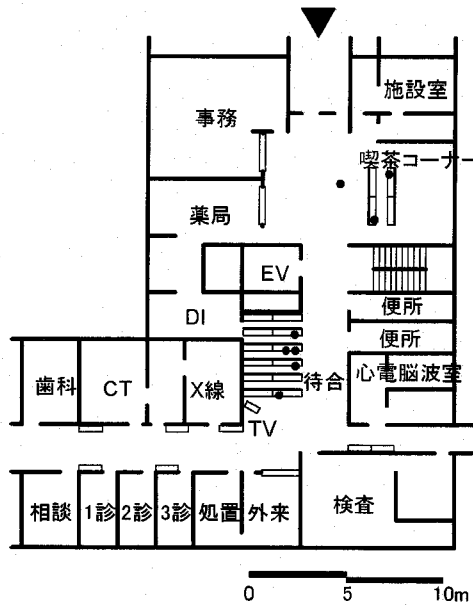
S病院1階外来平面図 (2001.10.23 11:00)
